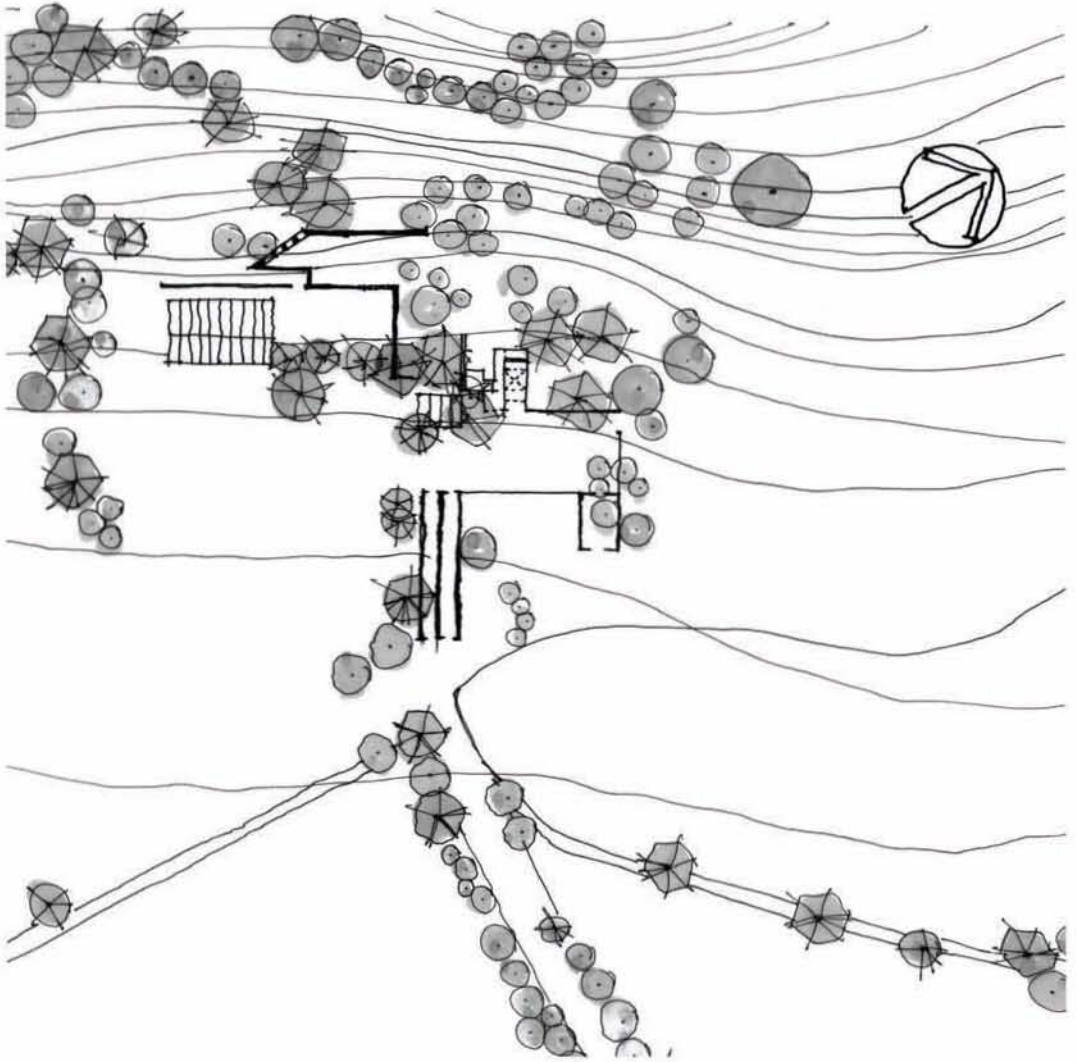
Reconstrucción de la Planta de Xochimancas, estado actual.
